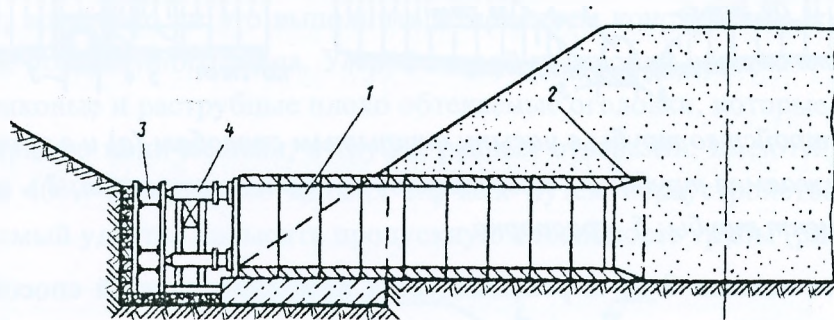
Устройство трубы в насыпи способом продавливания: 1 – звенья трубы; 2 – металлический нож; 3 – упорная рама; 4 – домкраты.
